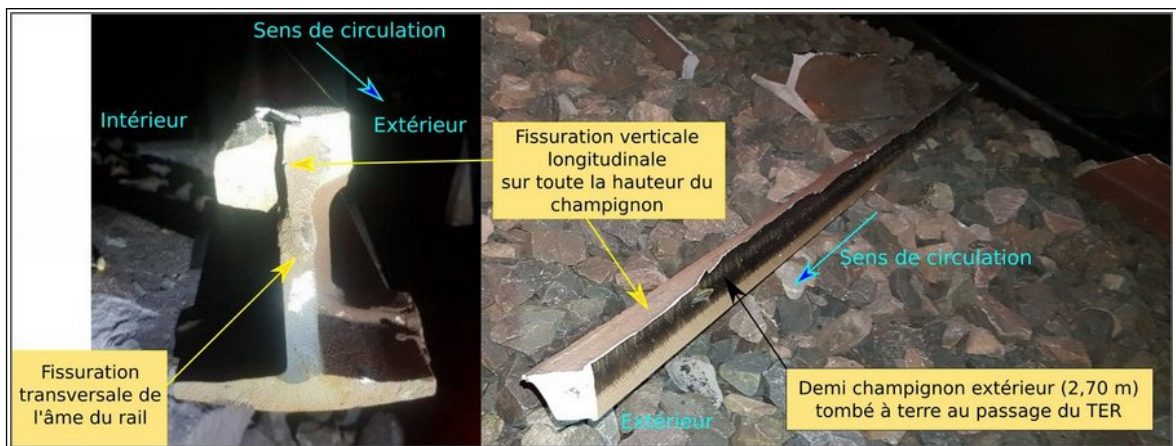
fissuration verticale du rail – champignon du rail tombé à l'extérieur de la voie
